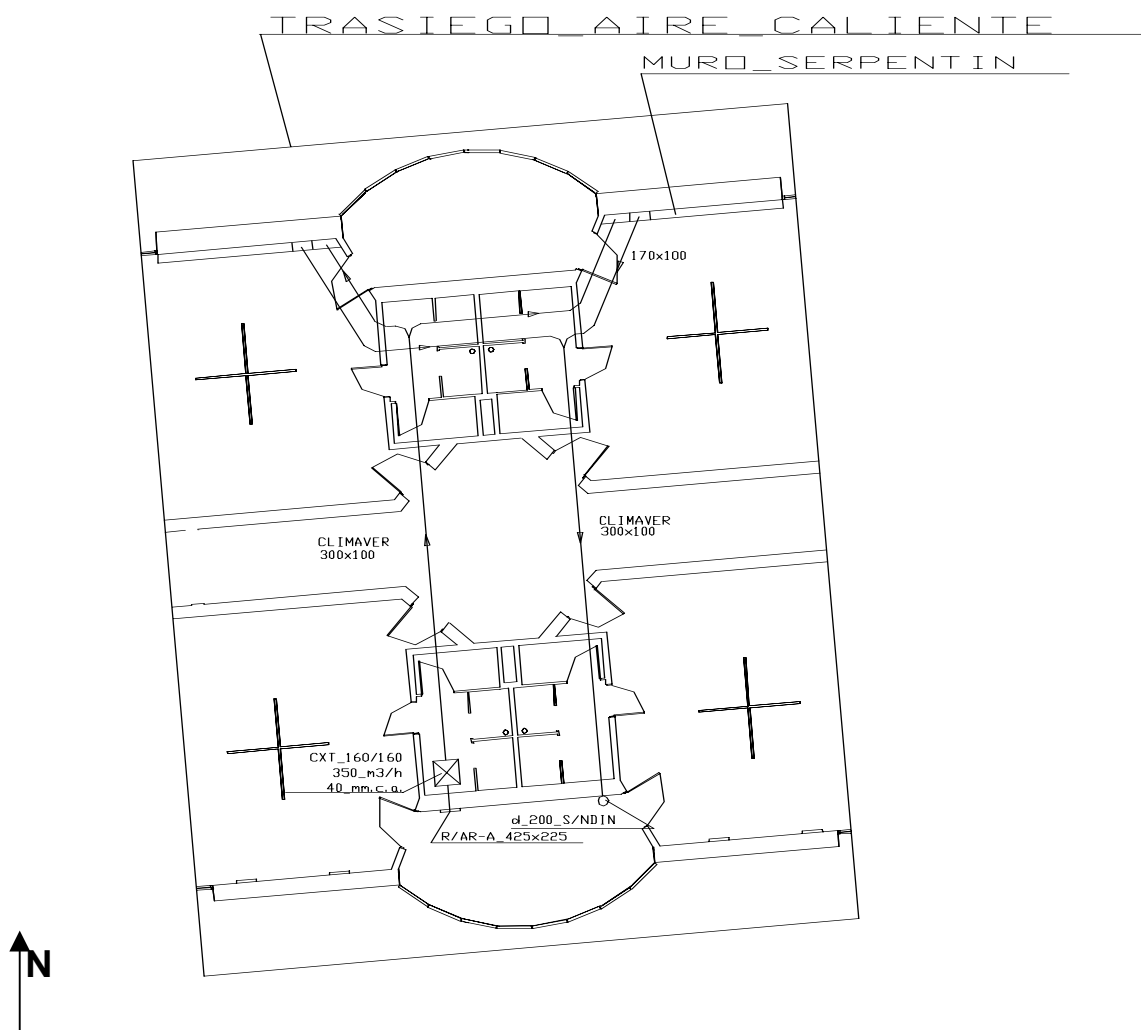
Plano del sistema de trasiego de energía a muros Norte.
